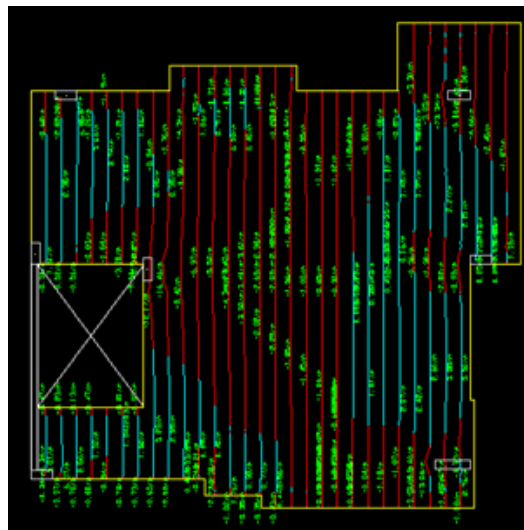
Grelha da laje do pavimento tipo no *software* TQS
